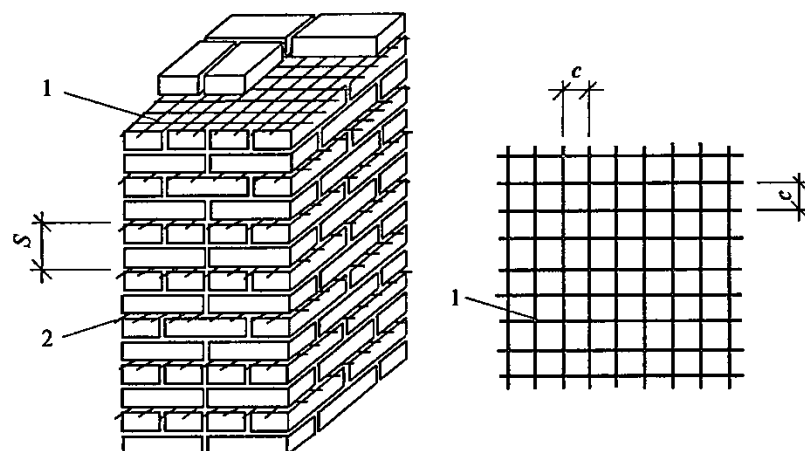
Поперечное (сетчатое) армирование каменных конструкций:
